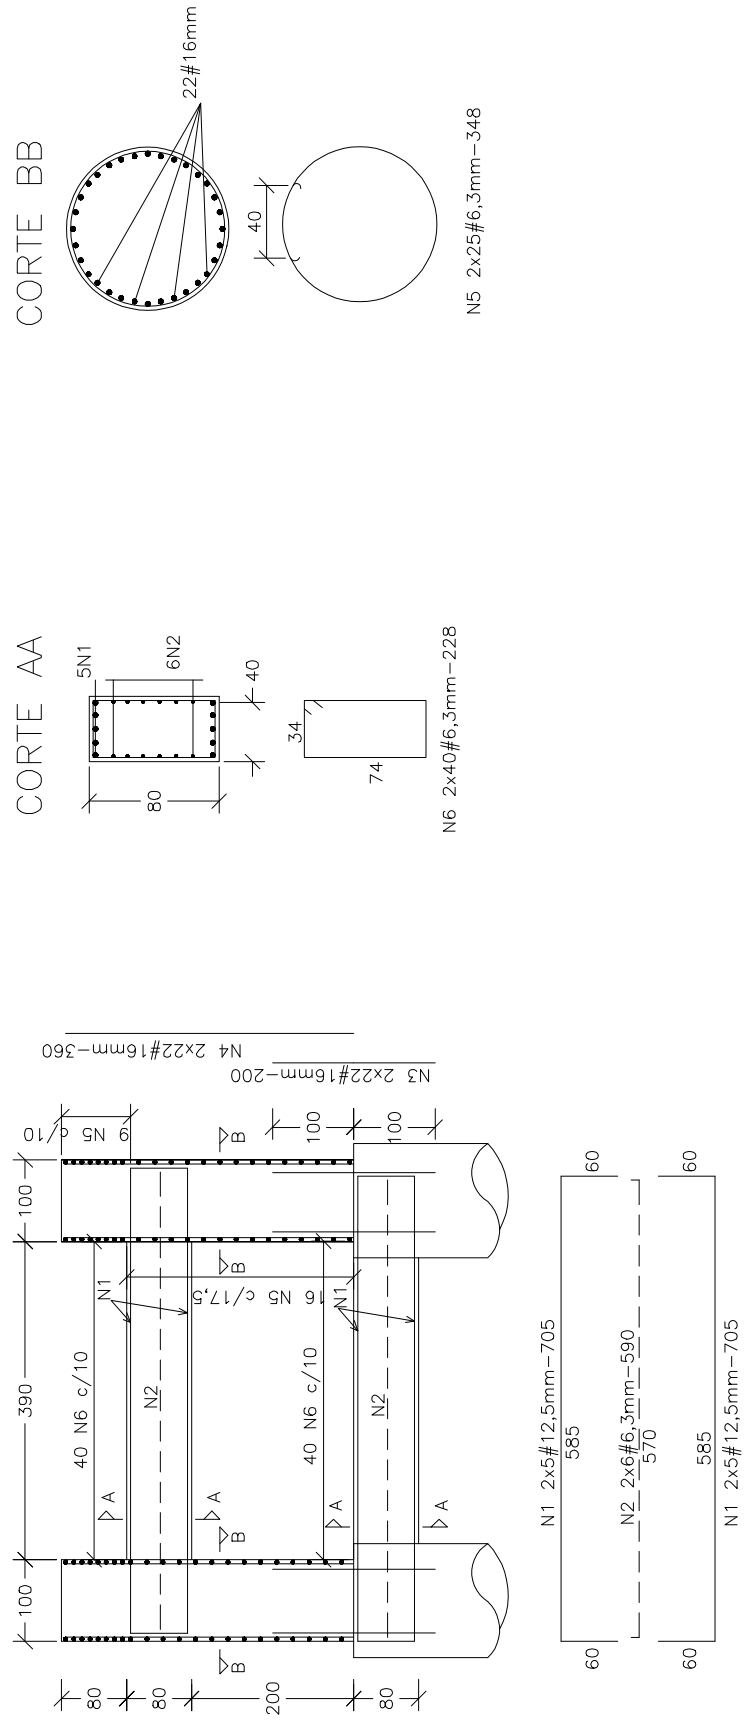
(c) - Detalhe da armadura do eixo 4 da ponte sobre o rio Pau seco.
